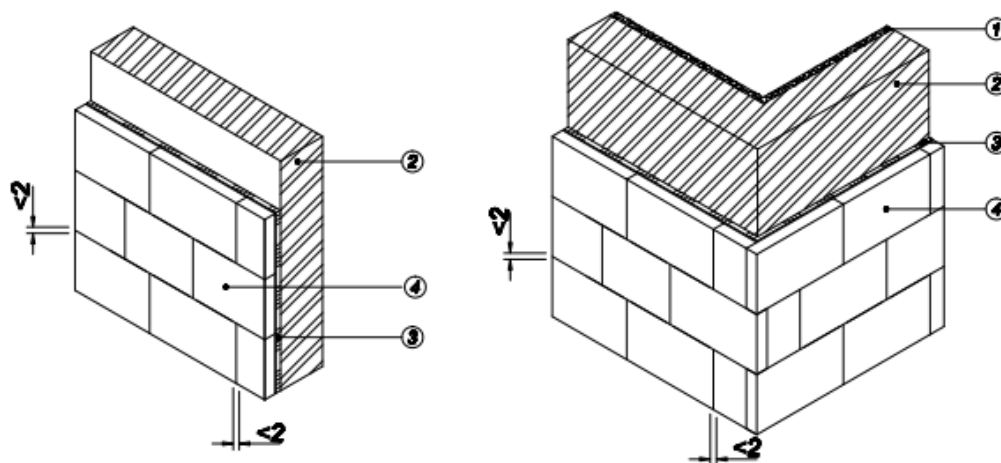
Перевязка стыков плит теплоизоляции на внутренних углах здания
